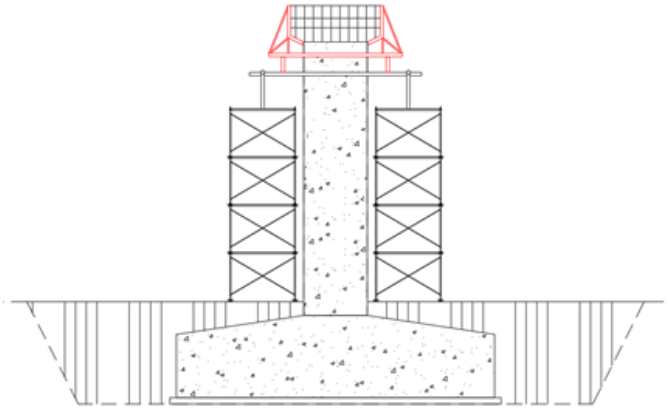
Pekerjaan penulangan kepala pilar
